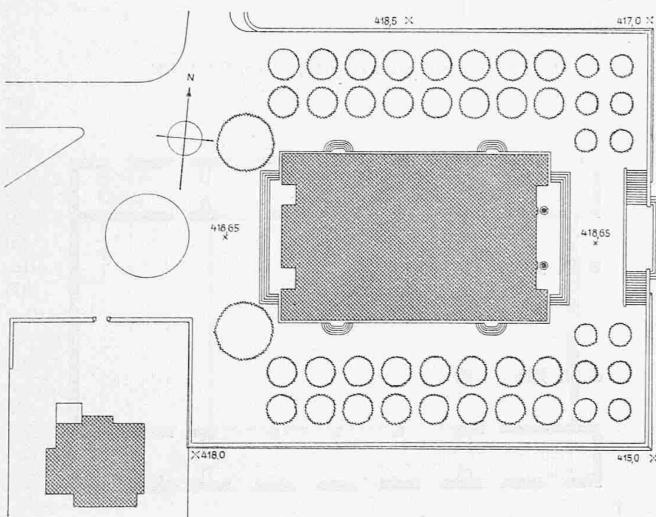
Lageplan von Kirche und Pfarrhaus. — Maßstab 1:1000.
